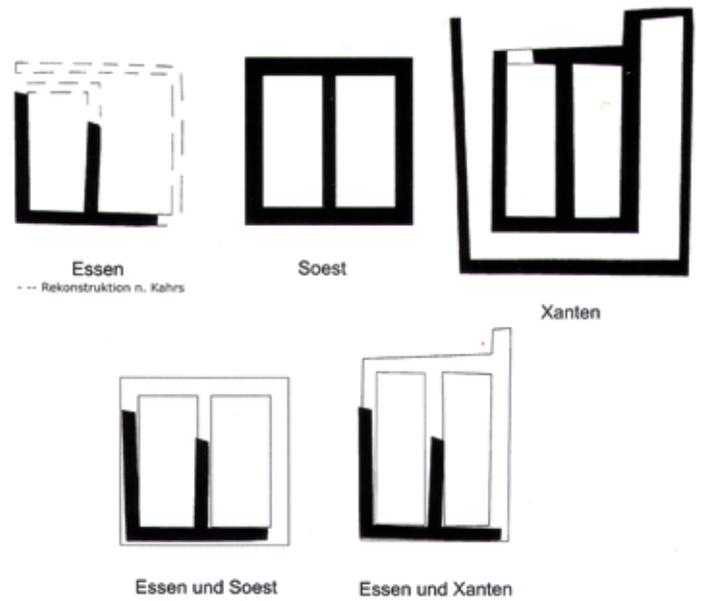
maßstäblicher Grundrissvergleich von Turmbauten von Essen, Soest und Xanten (aus: Hopp/Leenen 2010, Abb. 8). Abmessungen des Soester Grundrisses: 25 x 25 m
